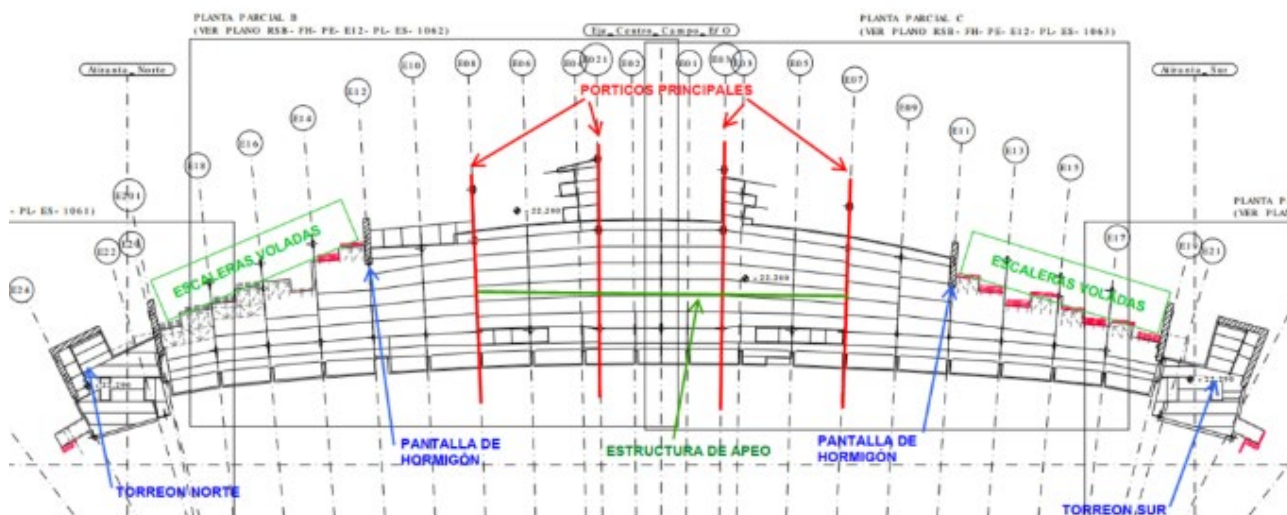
Planta con distribución de pórticos y elementos principales del Edificio Este
